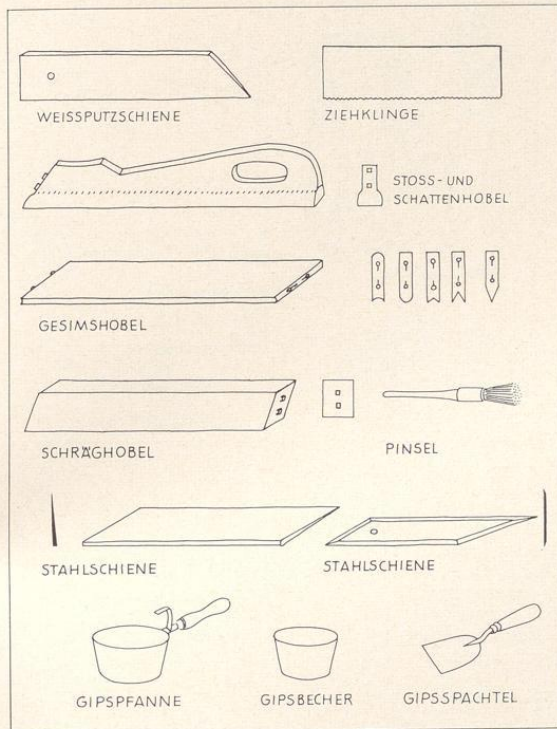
Werkzeuge zum Zuschneiden der Gesimsecken
